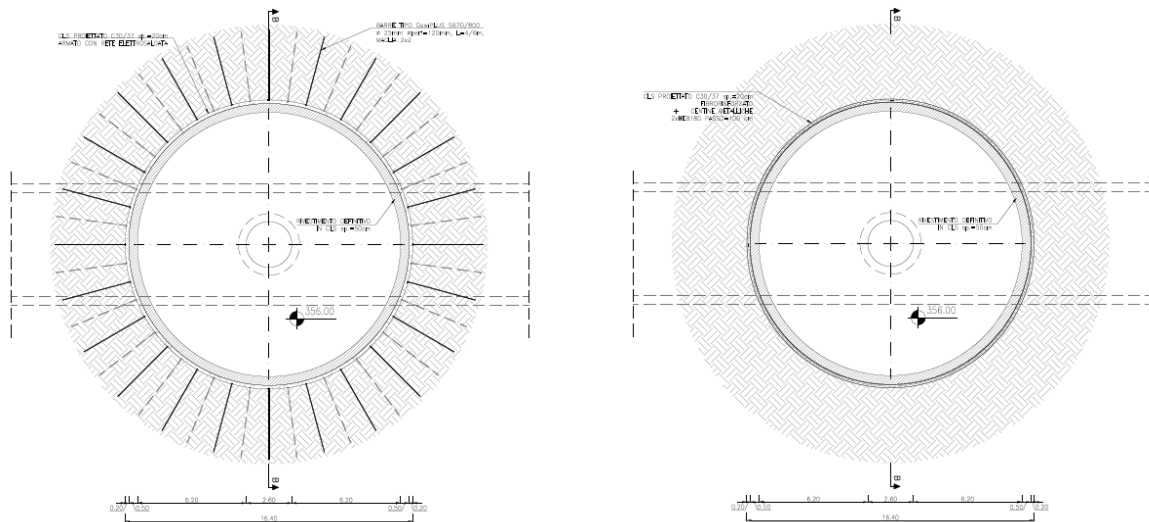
Sezioni tipo P\_Piez2 e P\_Piez3
